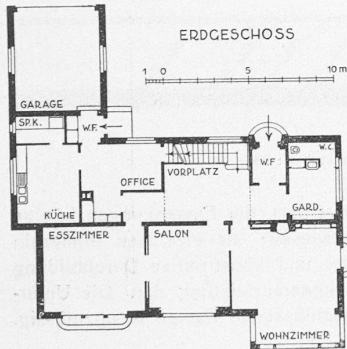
u. 11. Grundrisse zum Berghaus Baldern.
